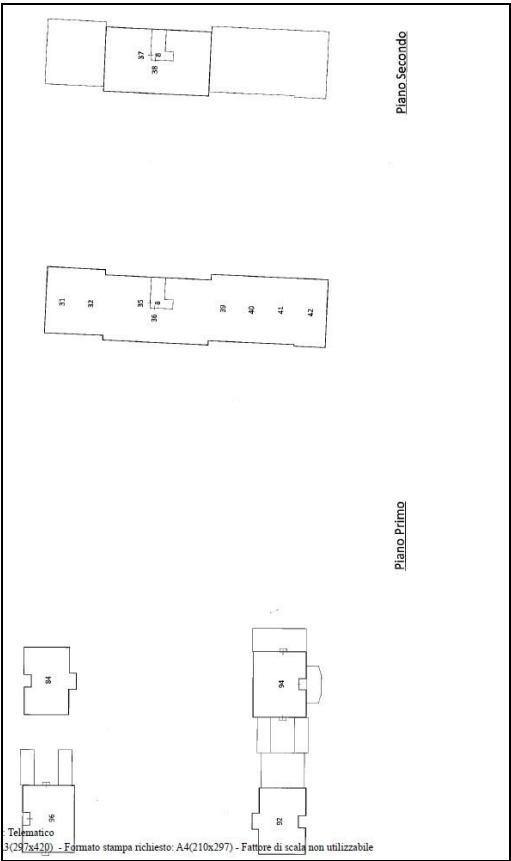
Planimetria subalterni piano primo e secondo (Allegato N.4)
